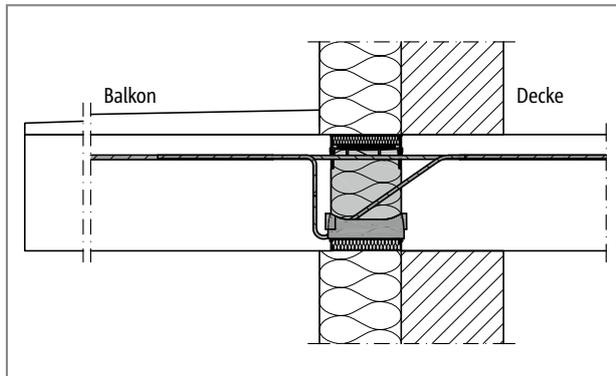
Schöck Isokorb® XT Typ K bei REI120: Verwendung als Brandriegel in Verbindung mit einer Stahlbetonbalkonplatte
